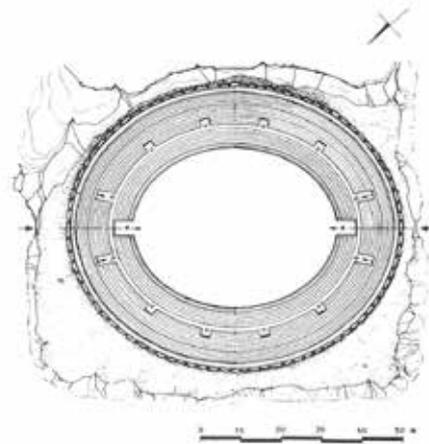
Pianta dell'anfiteatro di Sutri.
